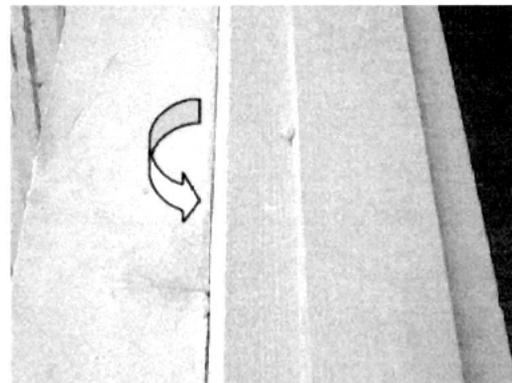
Défaut de liaison menuiserie-maçonnerie, zone d'infiltration des eaux.
